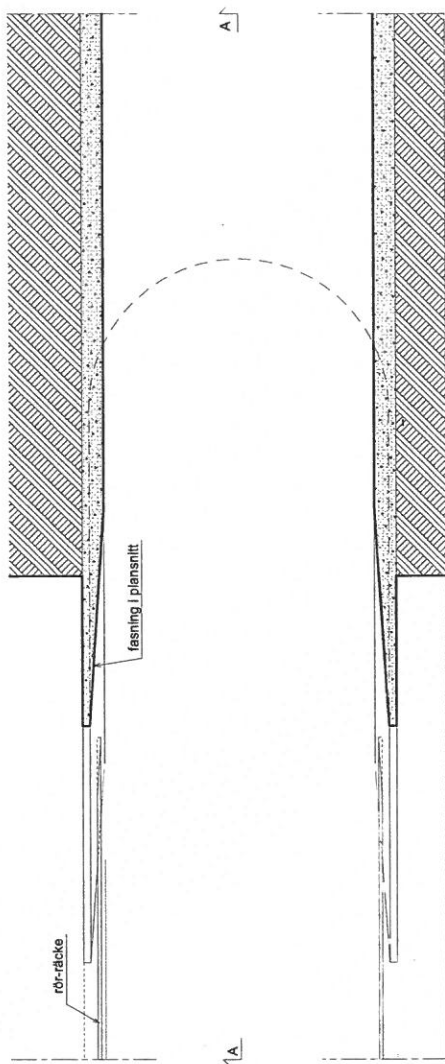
Principplan tunnelmynning Edeby, 1:200
